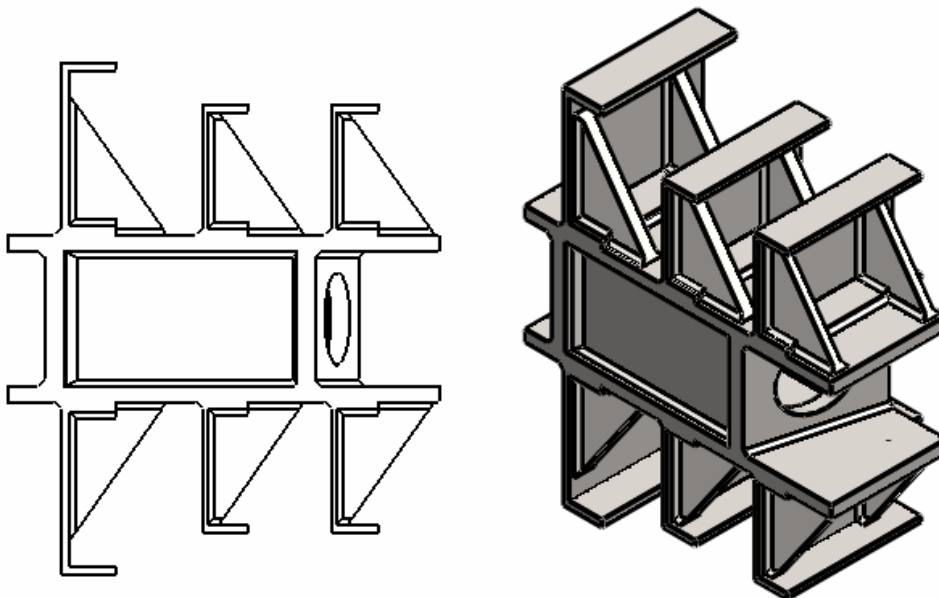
Vista lateral y modelo tridimensional de un anclaje como los que irán embebidos en la estructura de la torre de tirantes.
